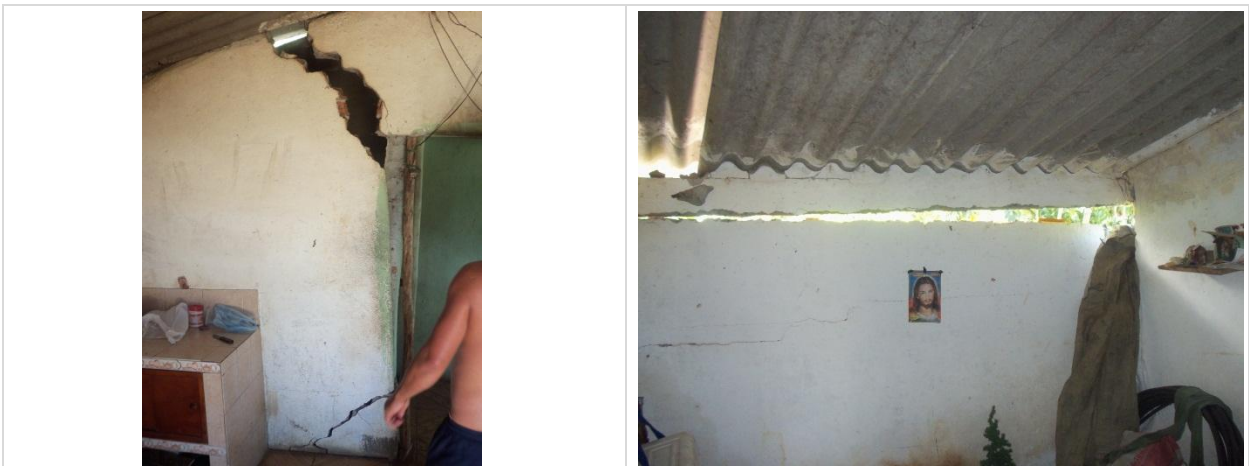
y 48. Vivienda Señorara. Maria Gutiérrez. Se presenta fisuramiento en muros. Corresponde a una construcción con muros en adobe y cubierta de teja de barro sobre estructura en madera rolliza. Tiene una antigüedad mayor a 30 años.
